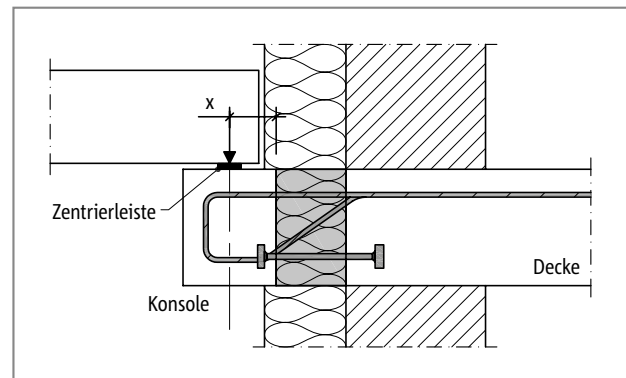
Schöck Isokorb® XT Typ O: Anschluss einer Konsole als Deckenauf- lager; Zentrierleisten verhindern eine Verschiebung des Lasteinleitungs- punktes
